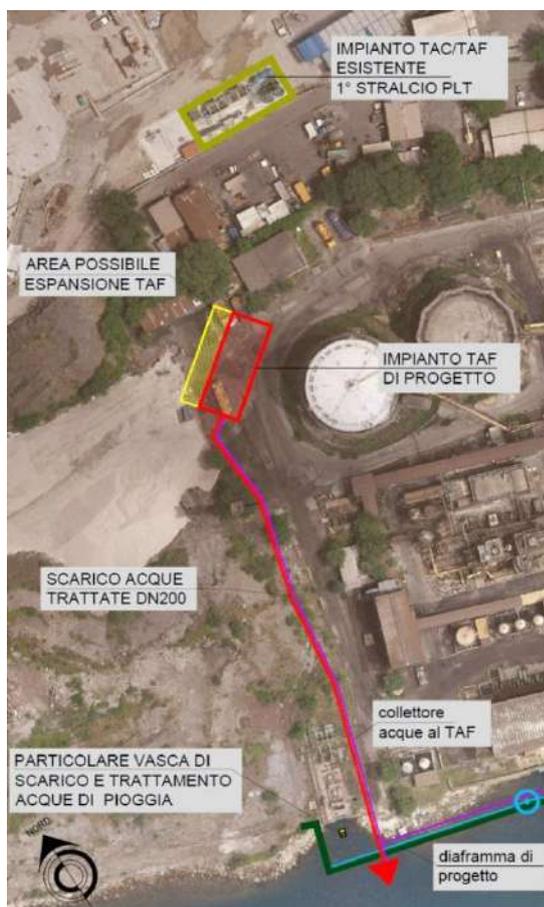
planimetria posizionamento impianto TAF e punto di scarico dell'impianto
